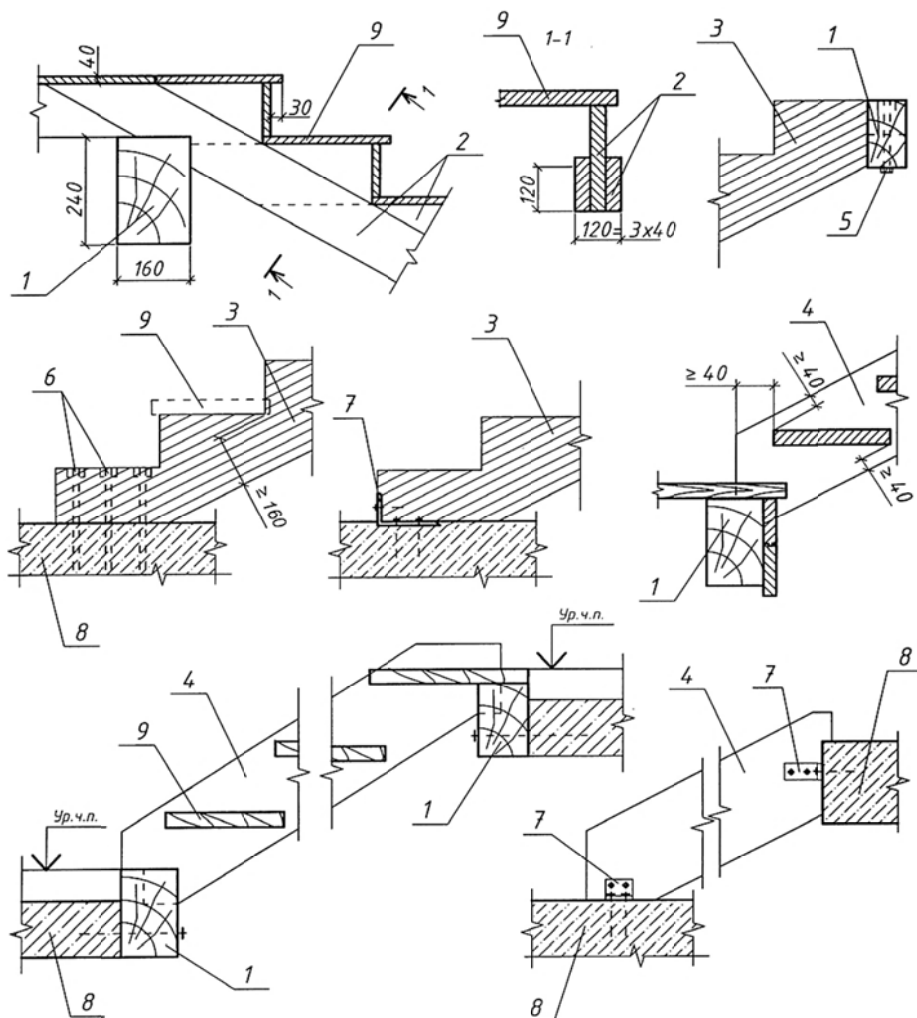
Конструктивные решения деревянных лестниц по косоурам и тетивам:
